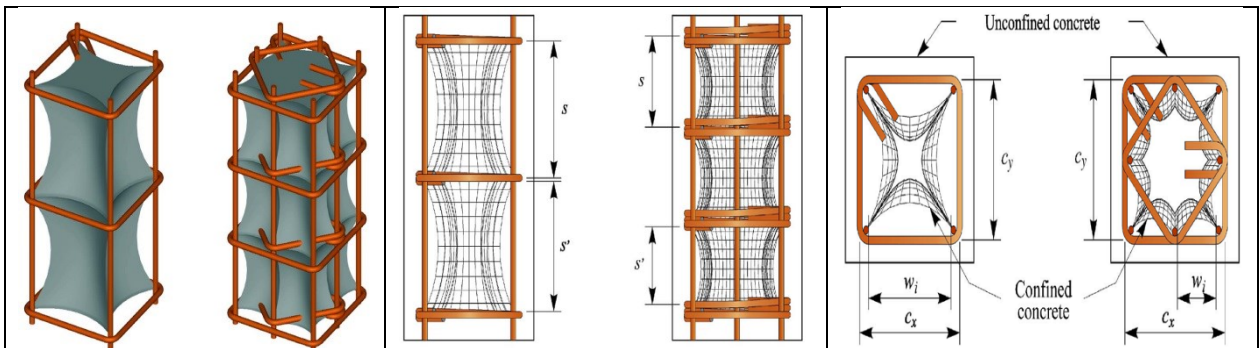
Efecto de confinamiento de armadura transversal dispuesta a lo largo de una columna, figura Paultre et al (2008)
